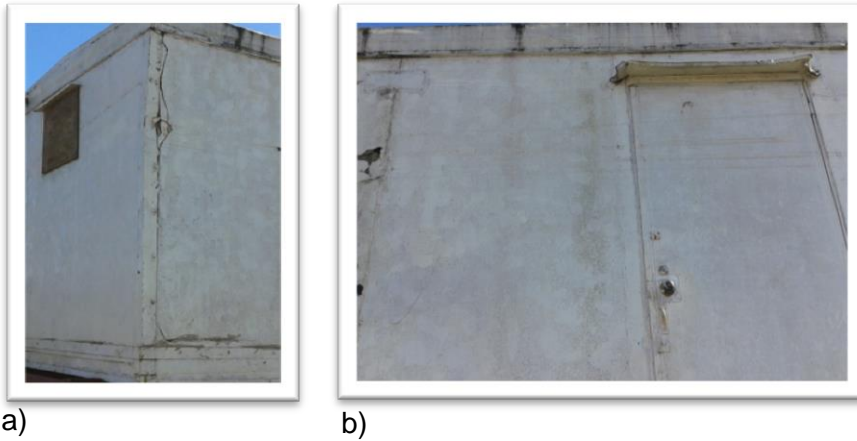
a) y b) Fotografías de la fachada de camper utilizado actualmente en Campos Geotérmicos
